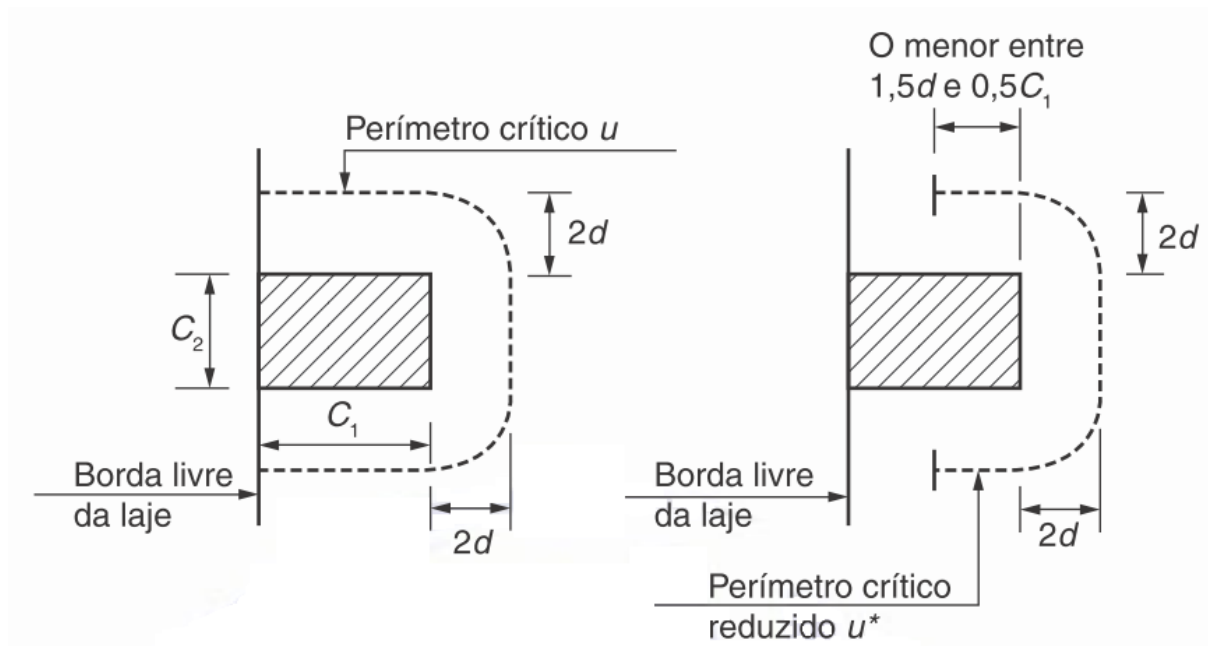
Perímetro crítico em pilares de borda (NBR 6118,2014)
